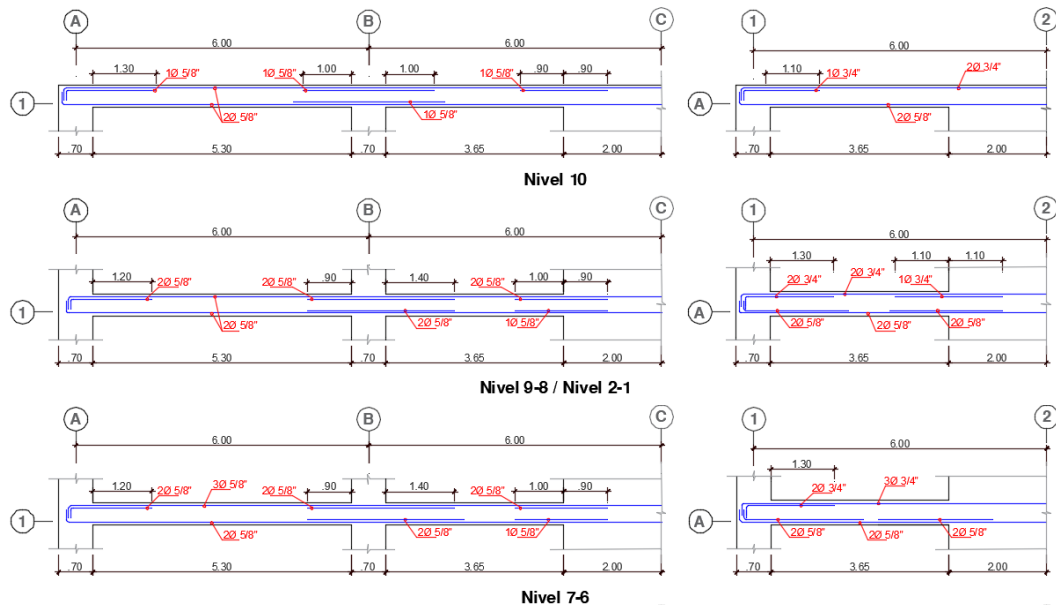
Refuerzo convencional requerido por flexión en las vigas para el edificio Edi-10
